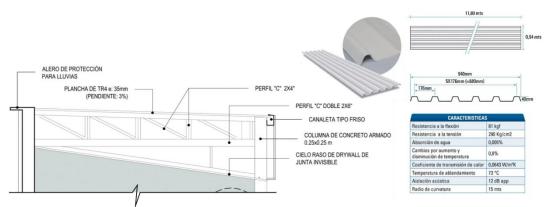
Detalle de estructura y cobertura liviana de la zona de exhibición.
